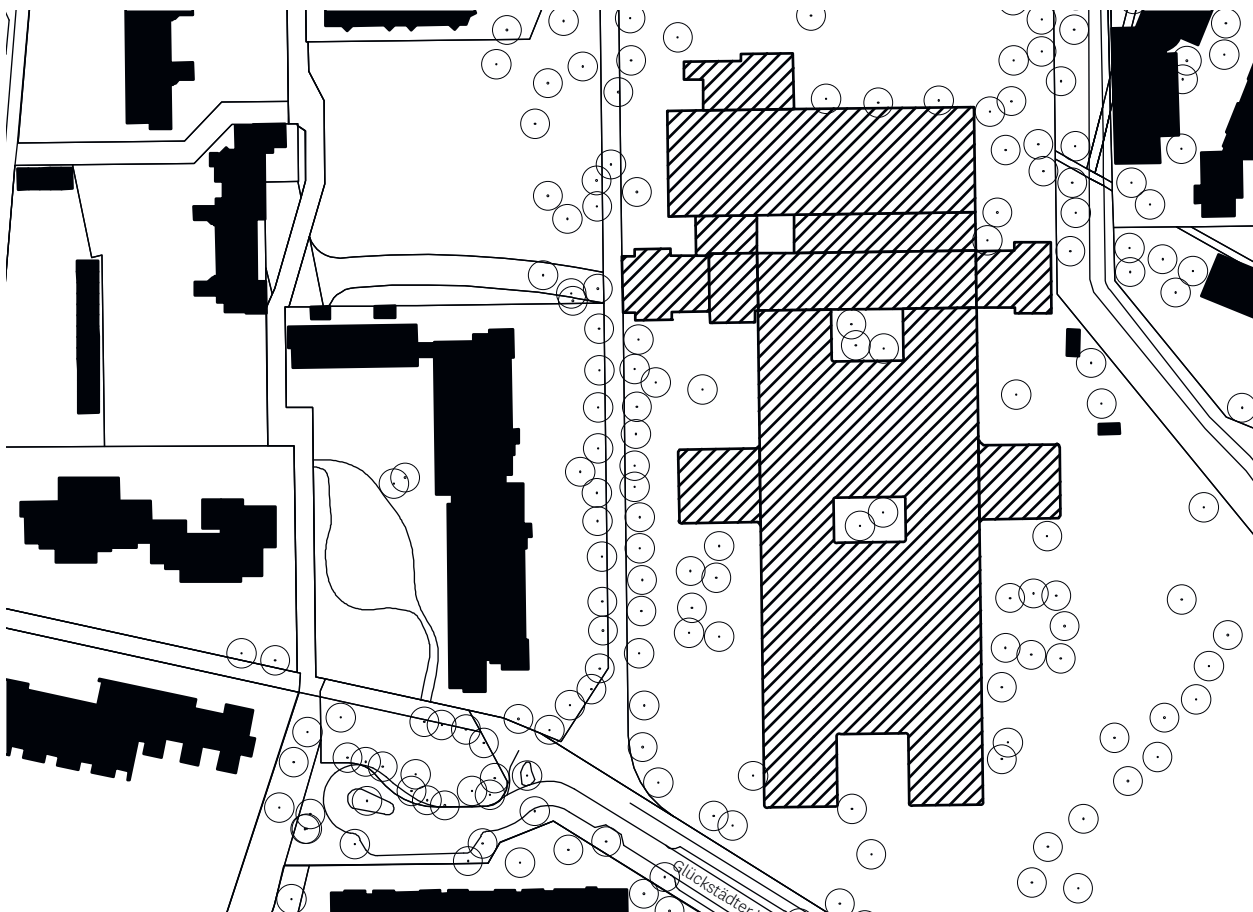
Lageplan genordet – Maßstab 1:2.000
